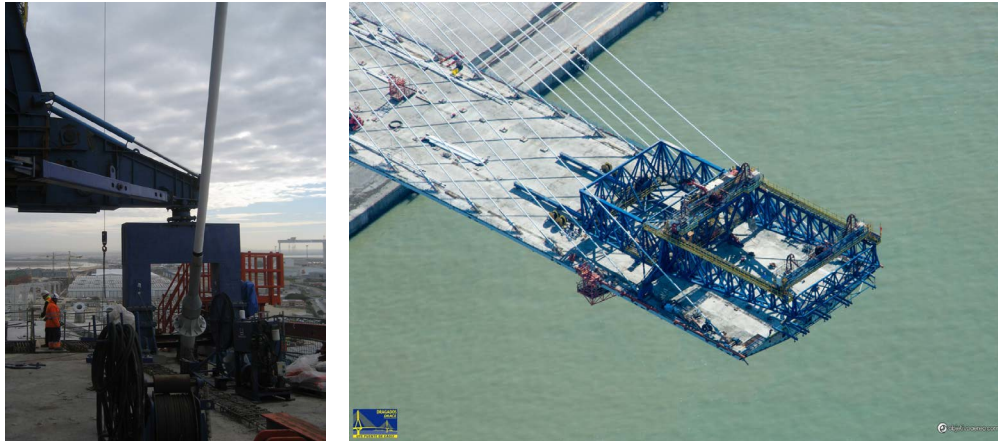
Carro de izado de dovelas apoyado en tirantes. Puente de la Constitución de 1812.
